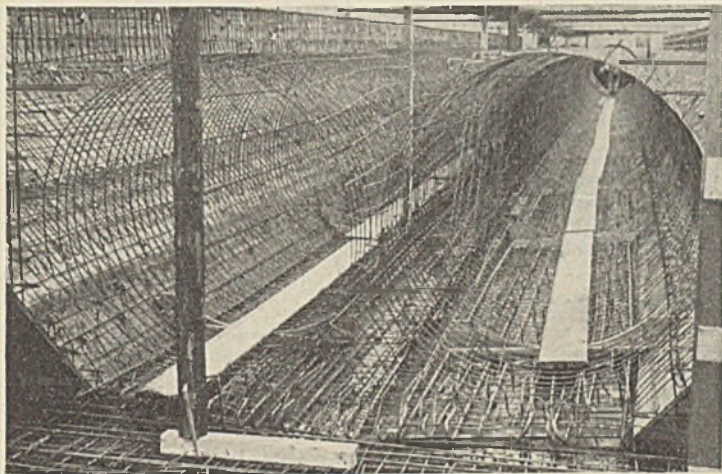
Bewehrung eines Schwimmkörpers im Bau.
